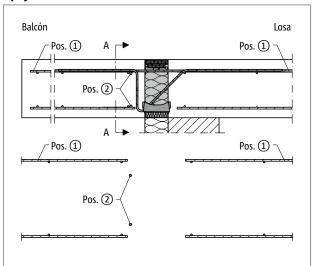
Schöck Isokorb® T tipo K-M1 hasta M11: Armadura in situ en caso de apoyo directo
